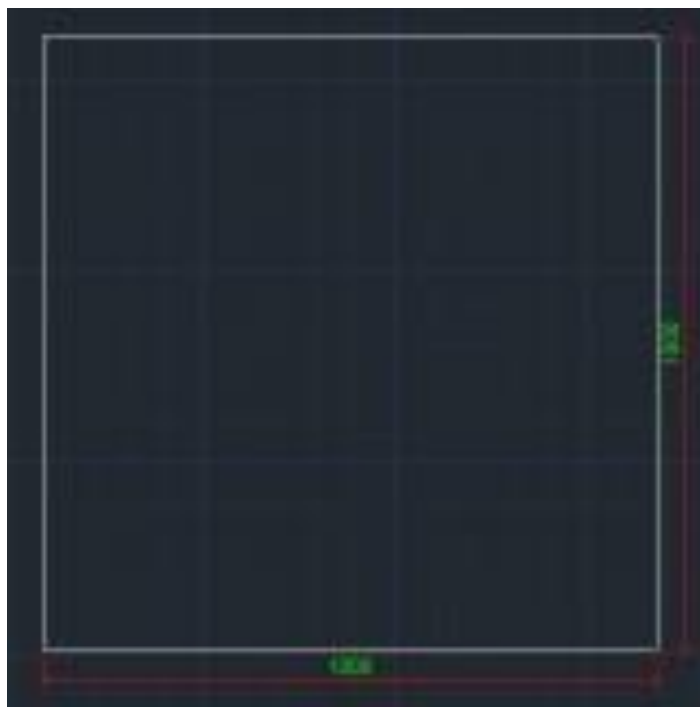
Область 1000x1000 см бетонной плиты перекрытия для будущего армирования
